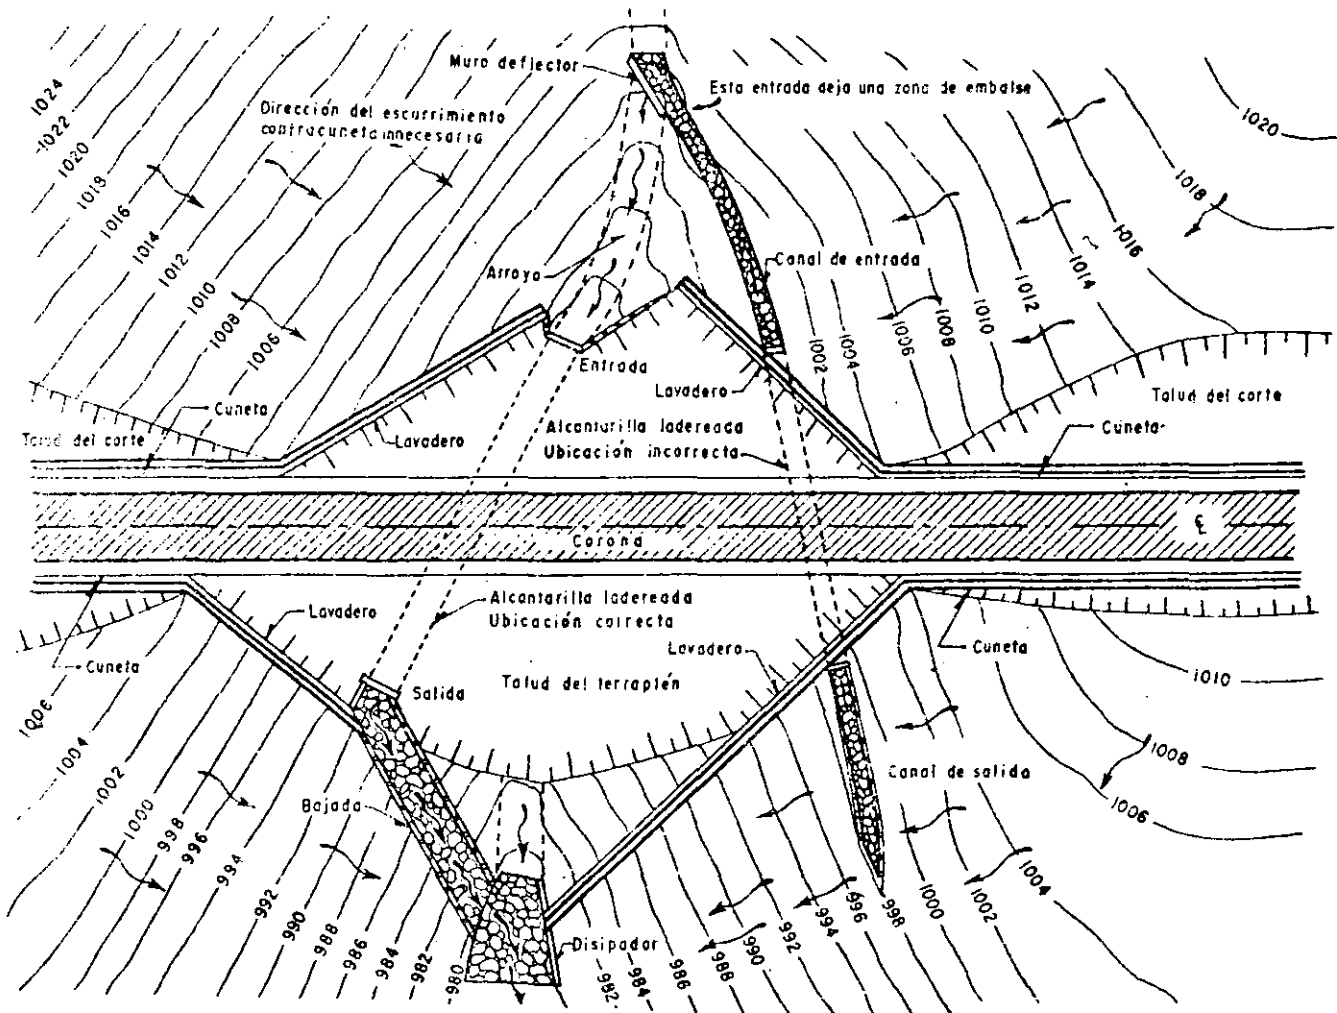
Ubicación de alcantarillas en laderas de cañadas.
